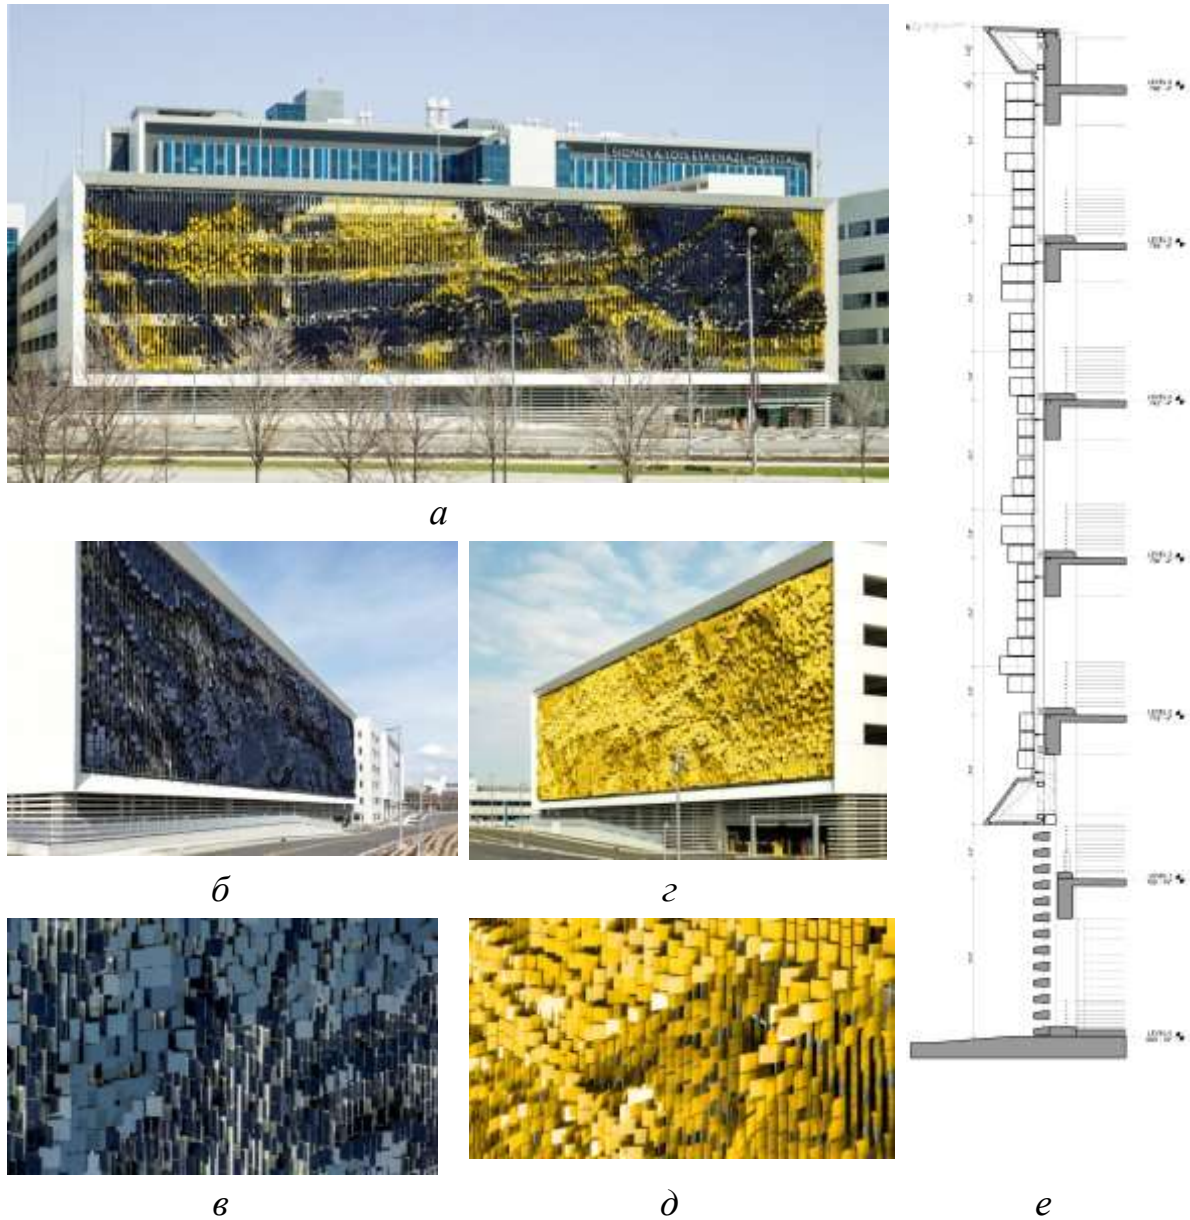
Parking Structure Art Facade / Rob Ley Studio.
